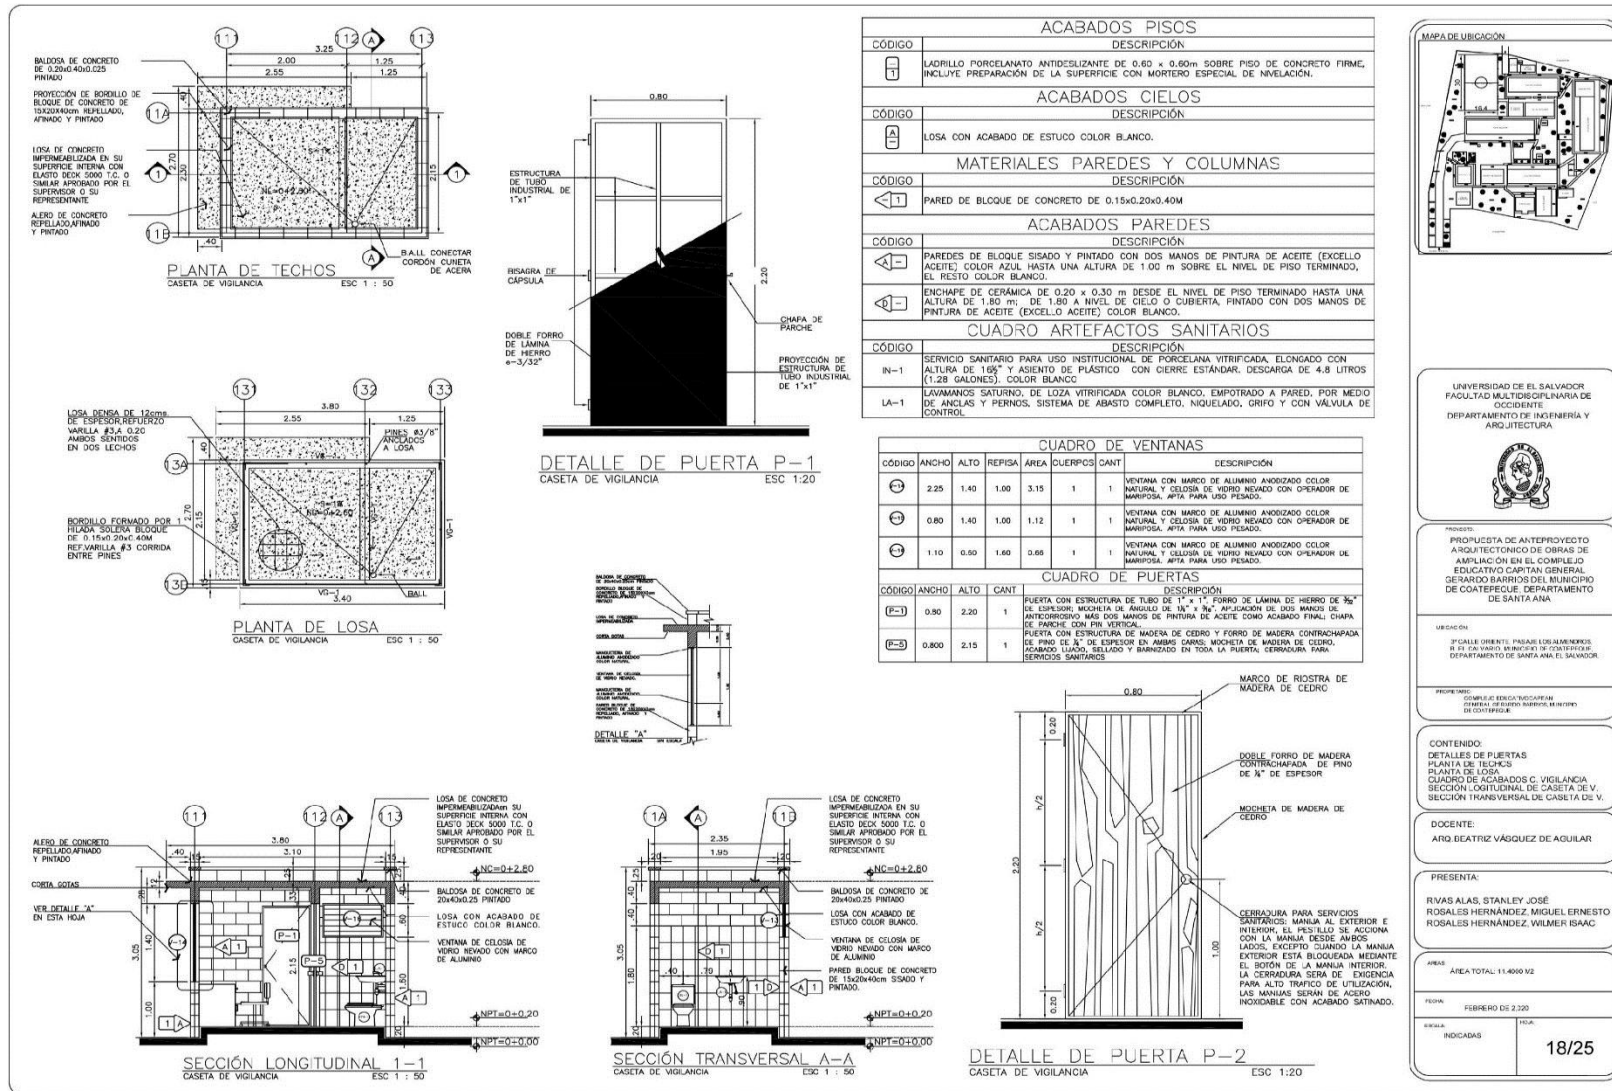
DETALLES CONSTRUCTIVOS, CASETA DE VIGILANCIA.
